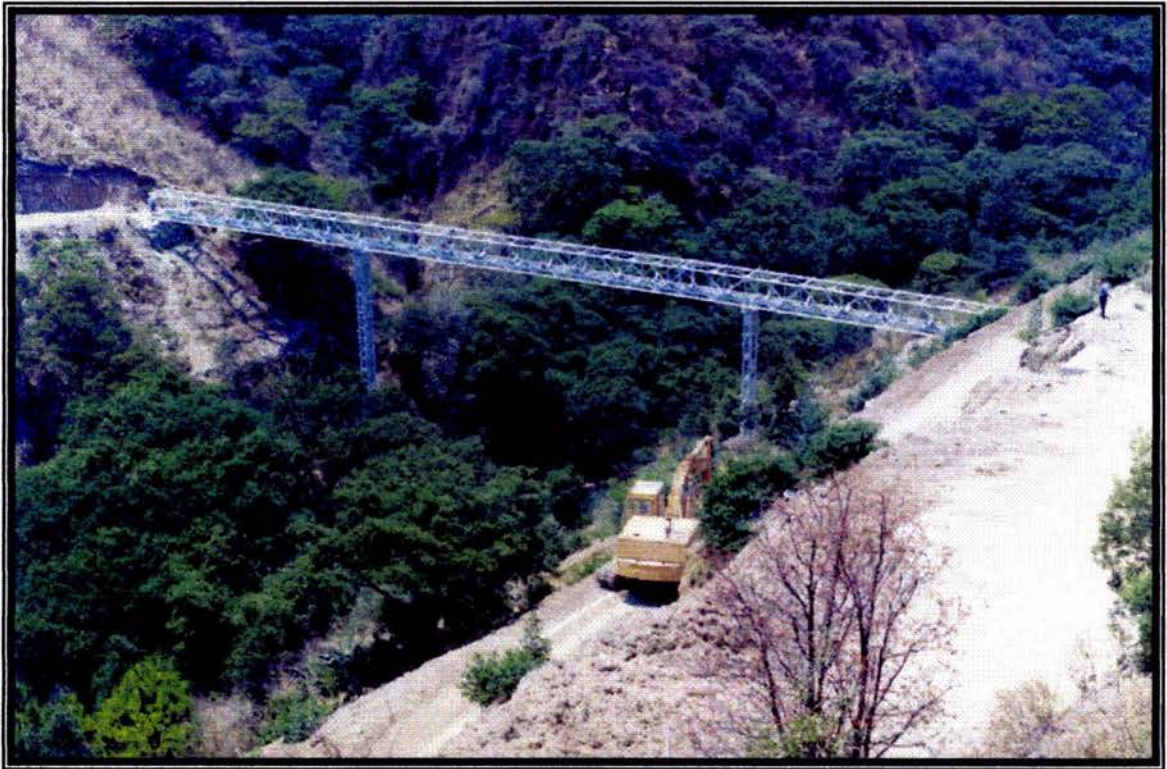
PUENTE DE ESTRUCTURA METÁLICA No. 1, PROPUETO PARA EL CRUCE DE LA BARRANCA
